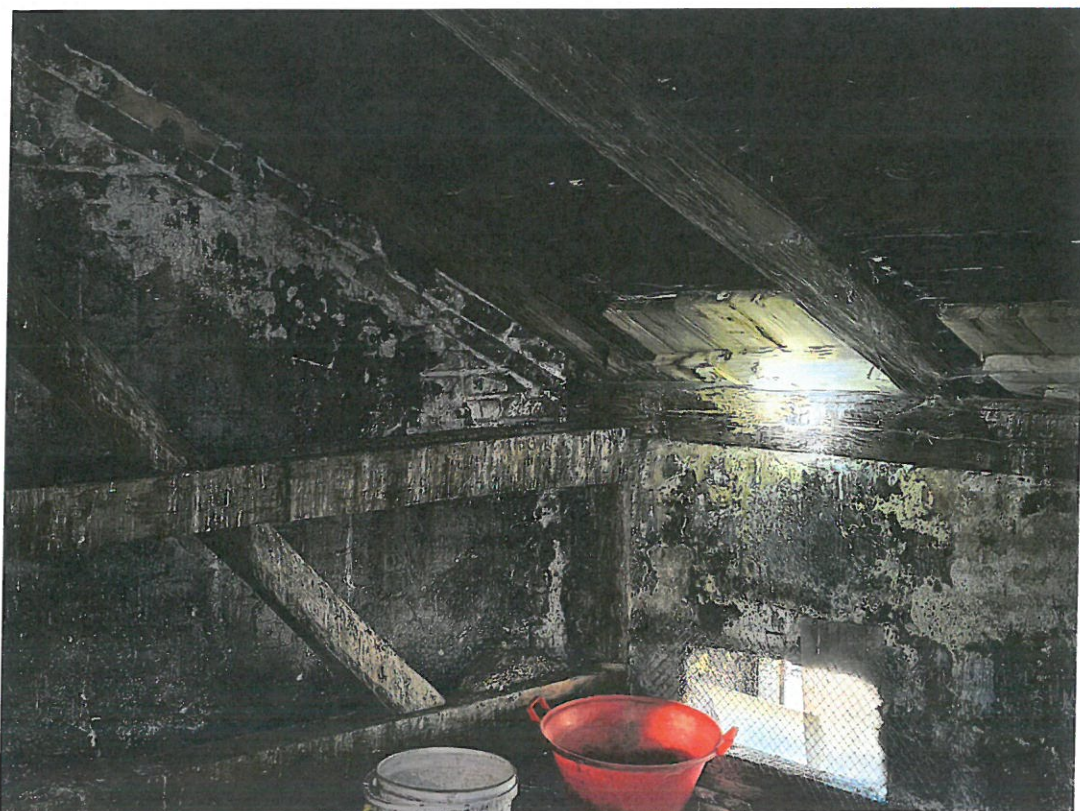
Prowizoryczne zabezpieczenie przed zalewaniem
